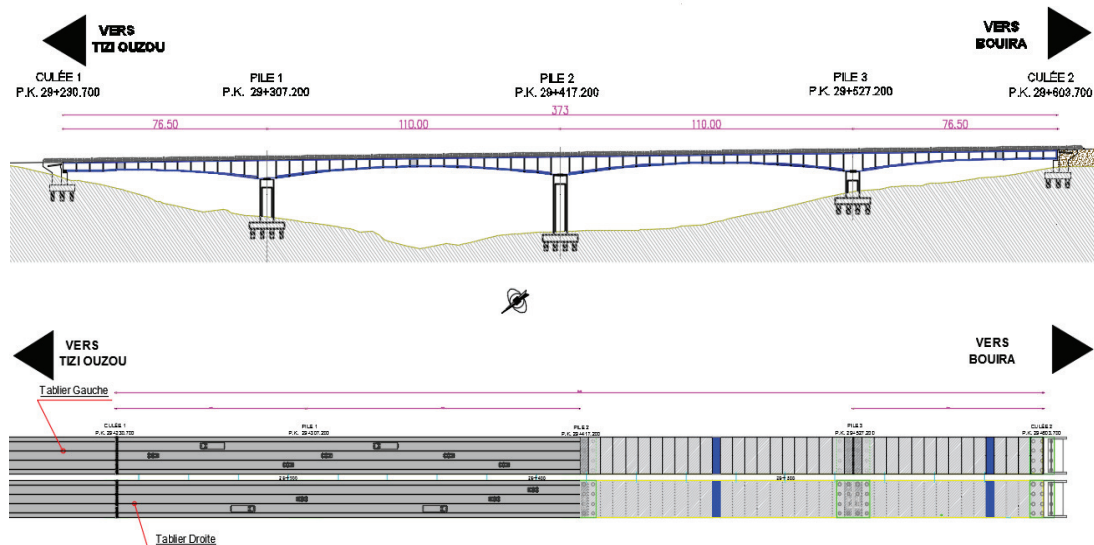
coupe longitudinale et vue en élévation du viaduc
